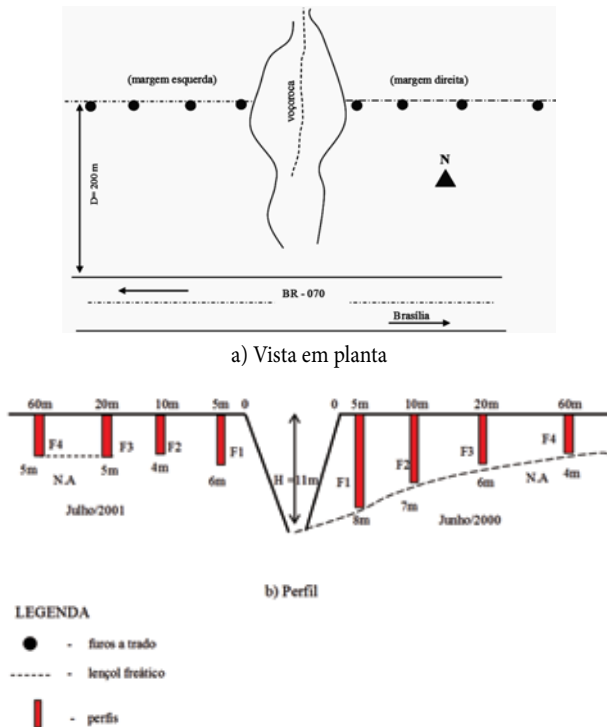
Croqui e esquema de retirada de amostras; a) vista em planta; b) vista em perfil (Lima, 2003).
